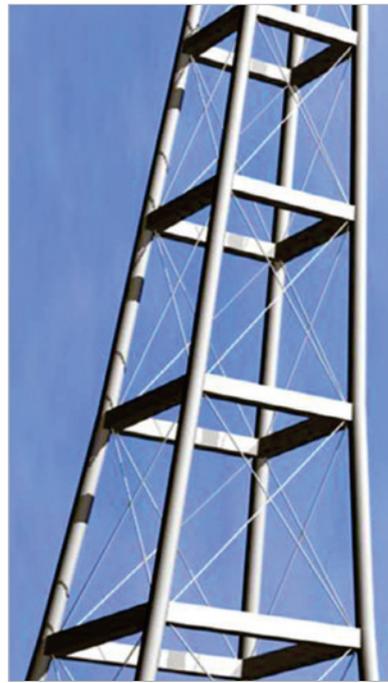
Pormenor da torre treliçada de concreto pré-moldado [08]
